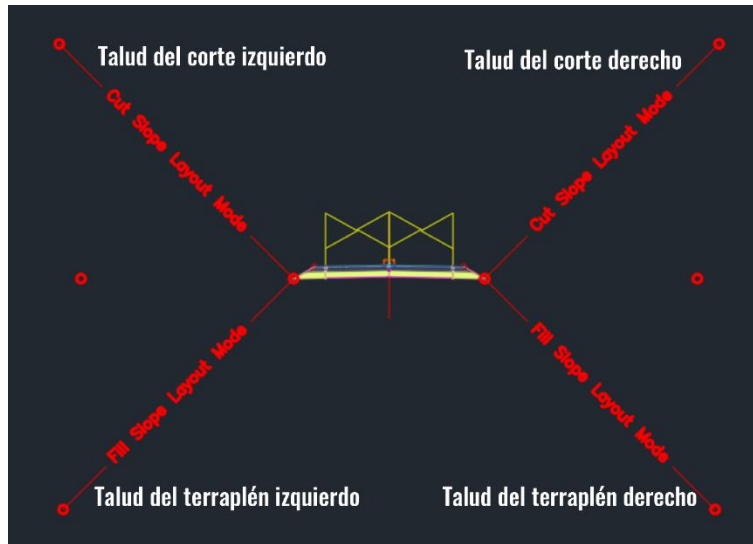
Corte y terraplén de la sección propuesta en assembly.
